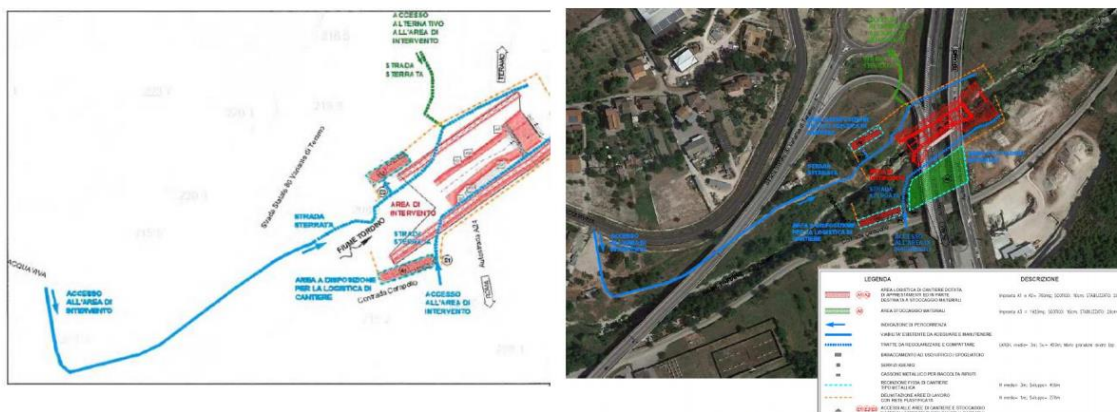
Planimetria di cantiere di progetto definitivo e esecutivo per gli interventi in corrispondenza del viadotto
